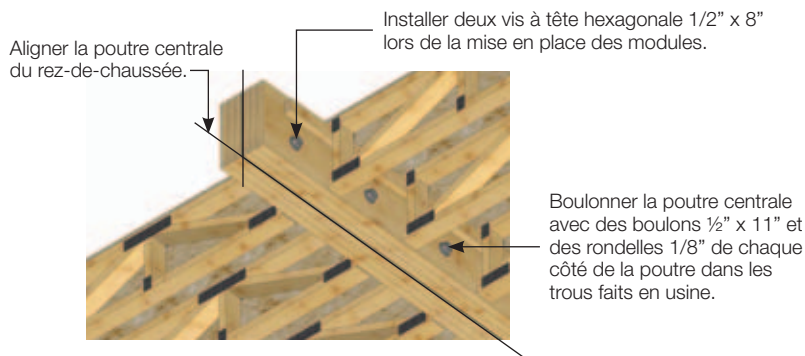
• Alignement et boulonnage de la poutre centrale du rez-de-chaussée
